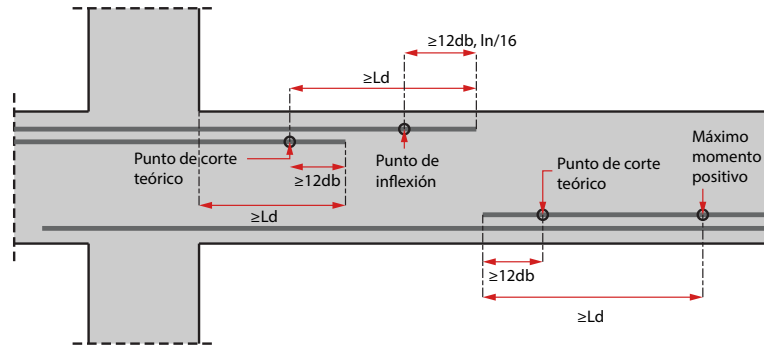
Consideraciones para el corte de hierro en vigas. Adaptado [Ottazzi, 2016b]
